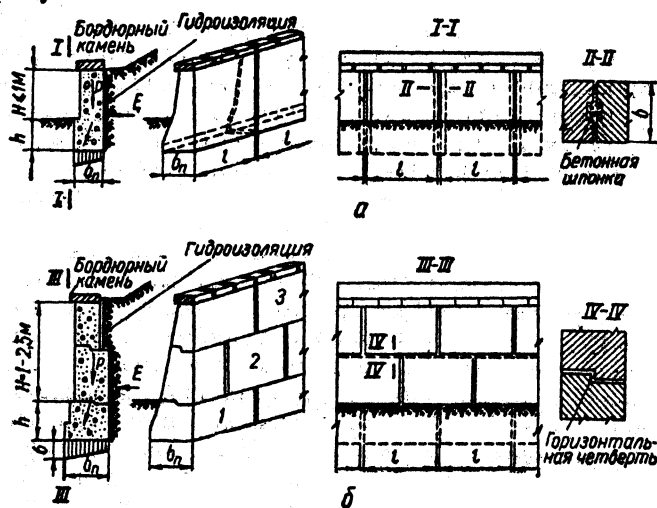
Массивные подпорные стенки из сборных бутобетонных и бетонных блоков:
